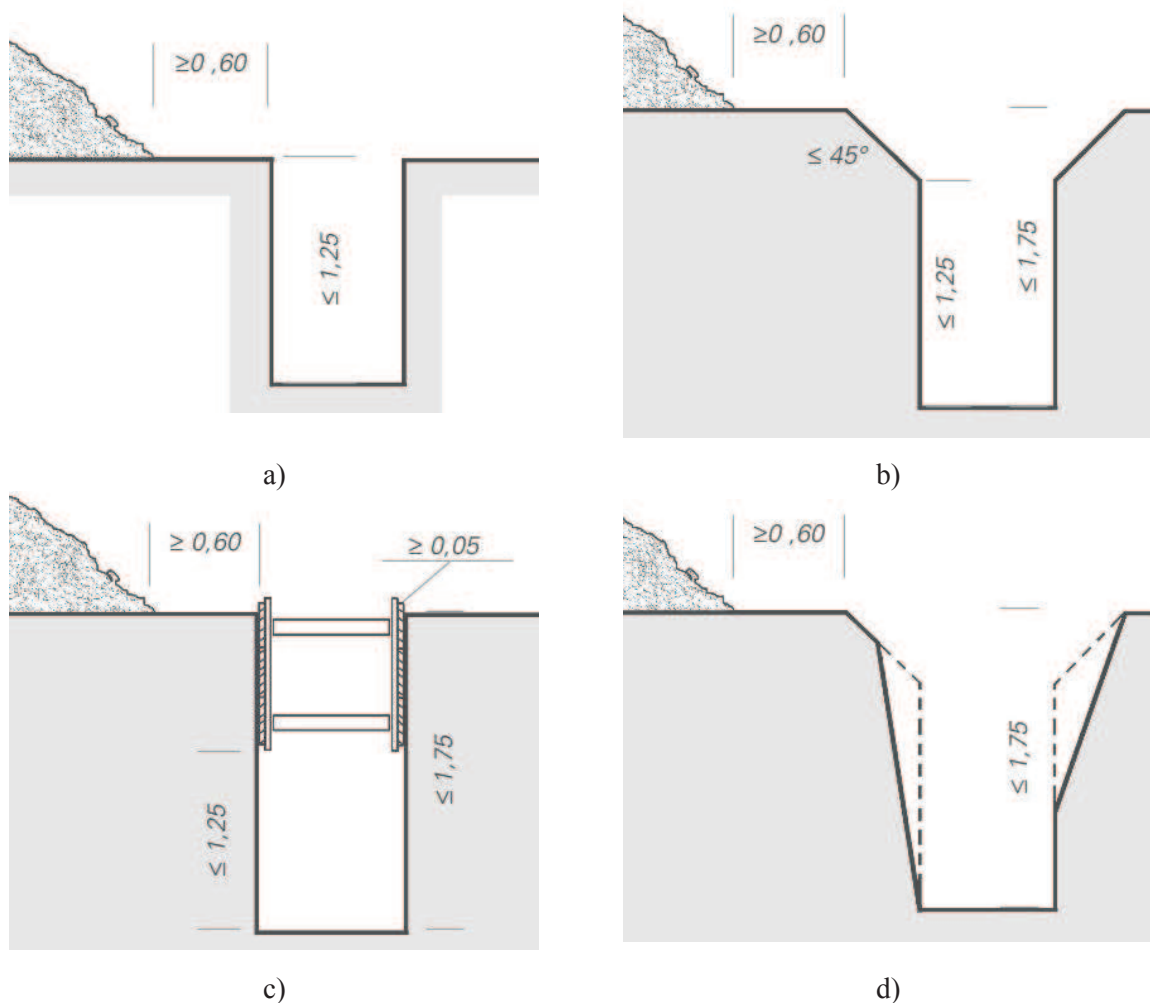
Escavações não suportadas, adaptado de (DIN 4124 2002-10)
